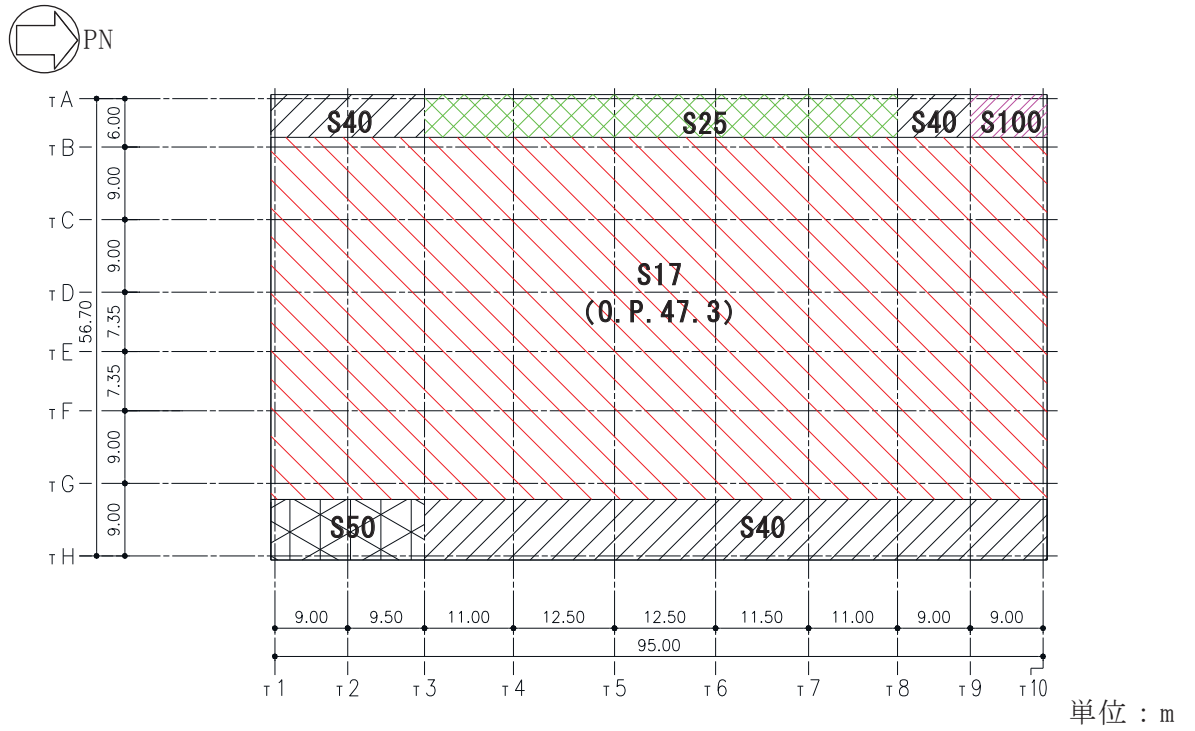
タービン建屋 屋根スラブの位置図 (O.P. 32.8)
